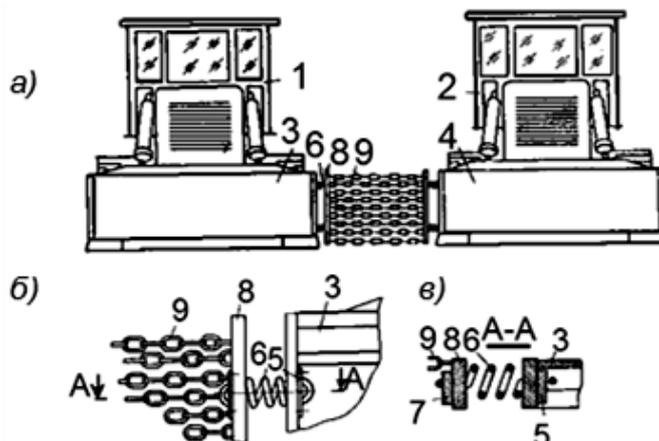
Спаренные бульдозеры: вид спереди (а), вид сзади на точку крепления цепей к боковине отвала (б), разрез А-А (в); 1 - базовый бульдозер; 2 - базовый бульдозер; 3, 4 - отвалы; 5 - накладка; 6 - пружина; 7 - накладка; 8 - вертикальная пластина; 9 - цепь
